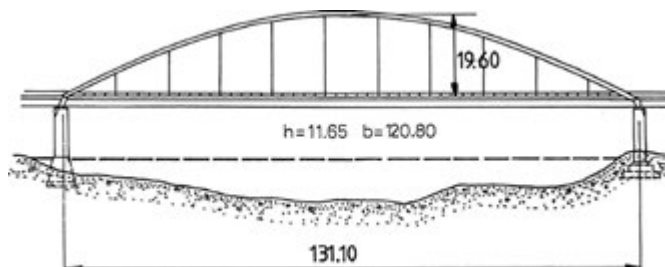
Podul „Fr. J. Strauss”. Elevație
